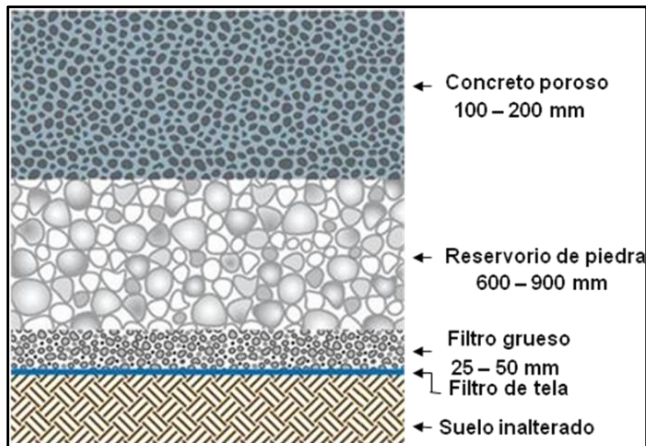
Sección típica de un sistema de pavimento concreto poroso [13]
